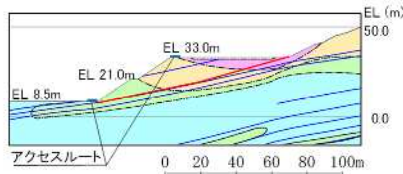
(1) 解析モデル図 (a-a' 断面)
